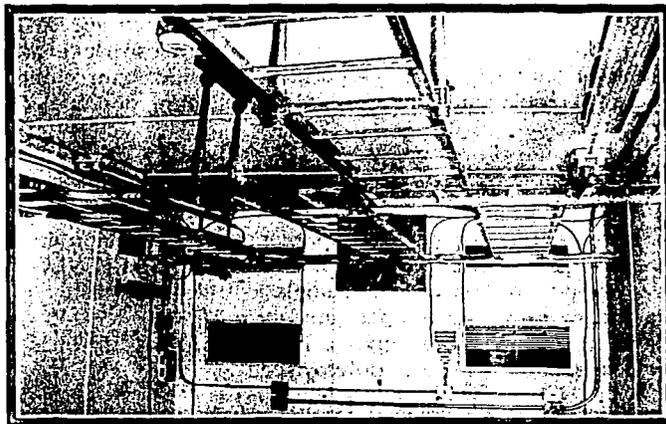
Fotografía de las escalerillas para el transporte de cables instaladas en el techo de un contenedor.
